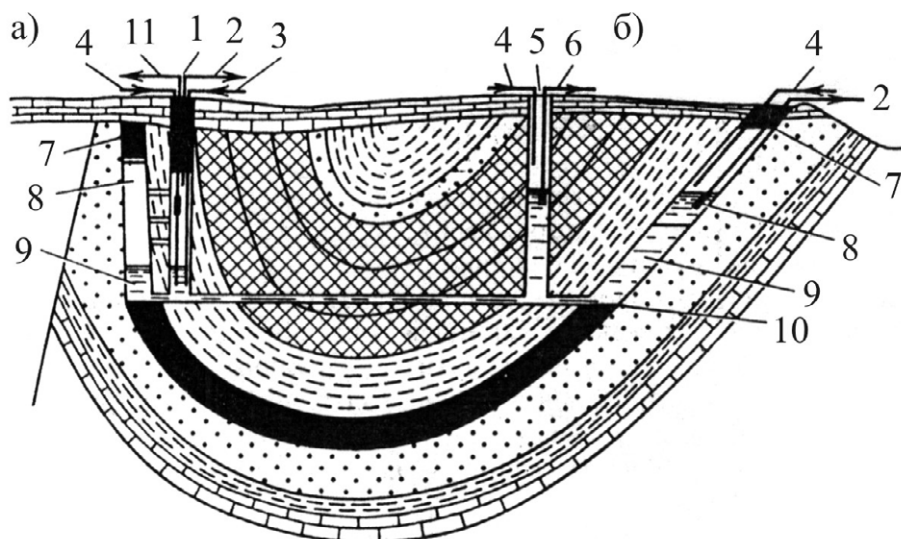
Поперечный разрез нефтехранилища в выработках отработанной шахты (Франция)
